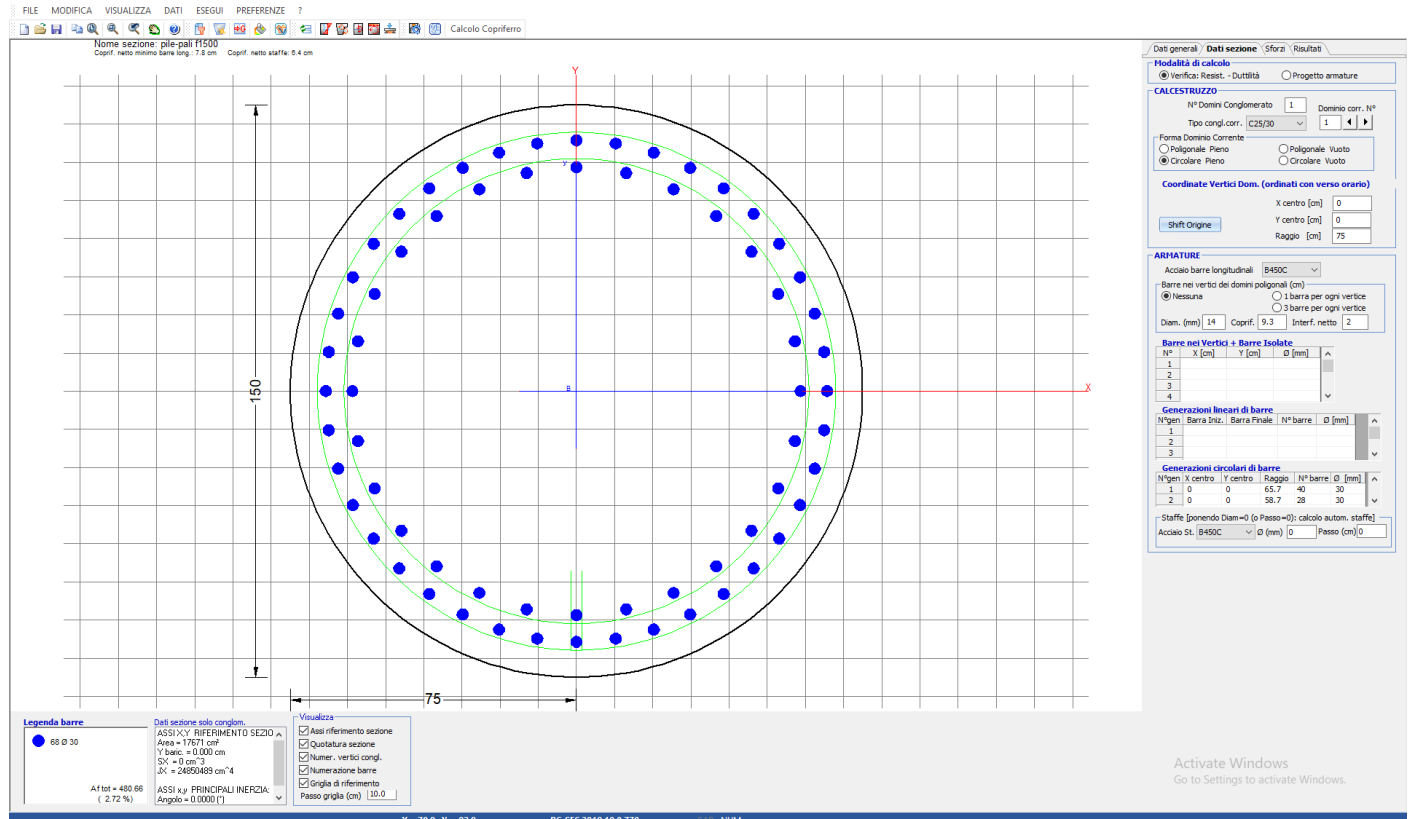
Pali di fondazione – Geometria sezione di verifica
